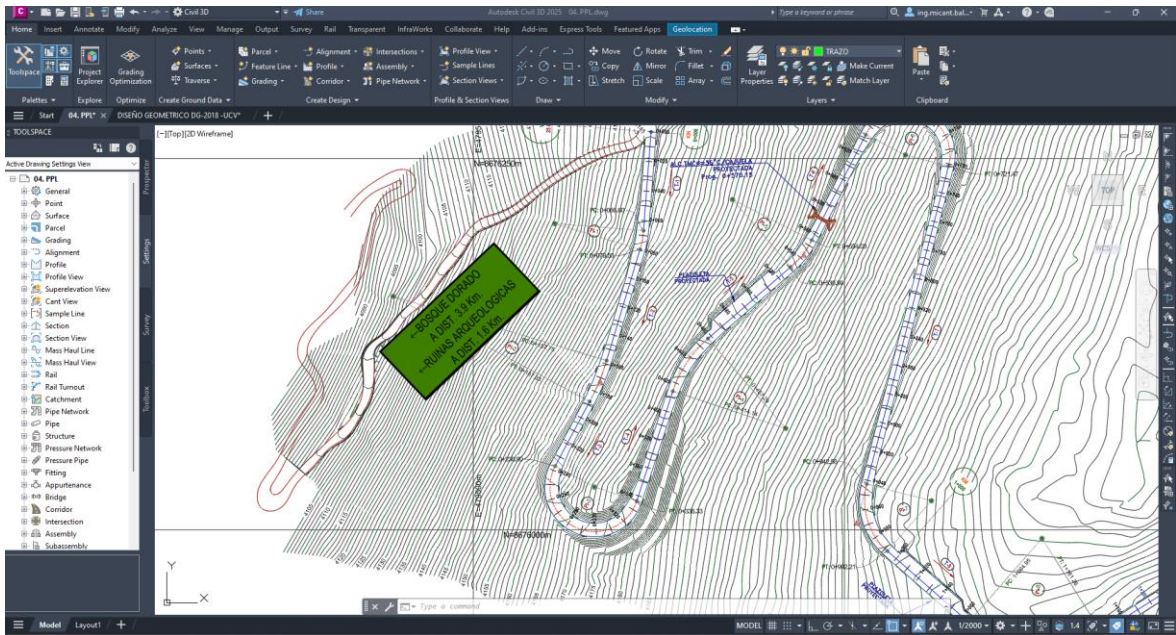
Representación en vista de planta de una berma ubicada en el kilómetro 0+320.00 de la vía.
